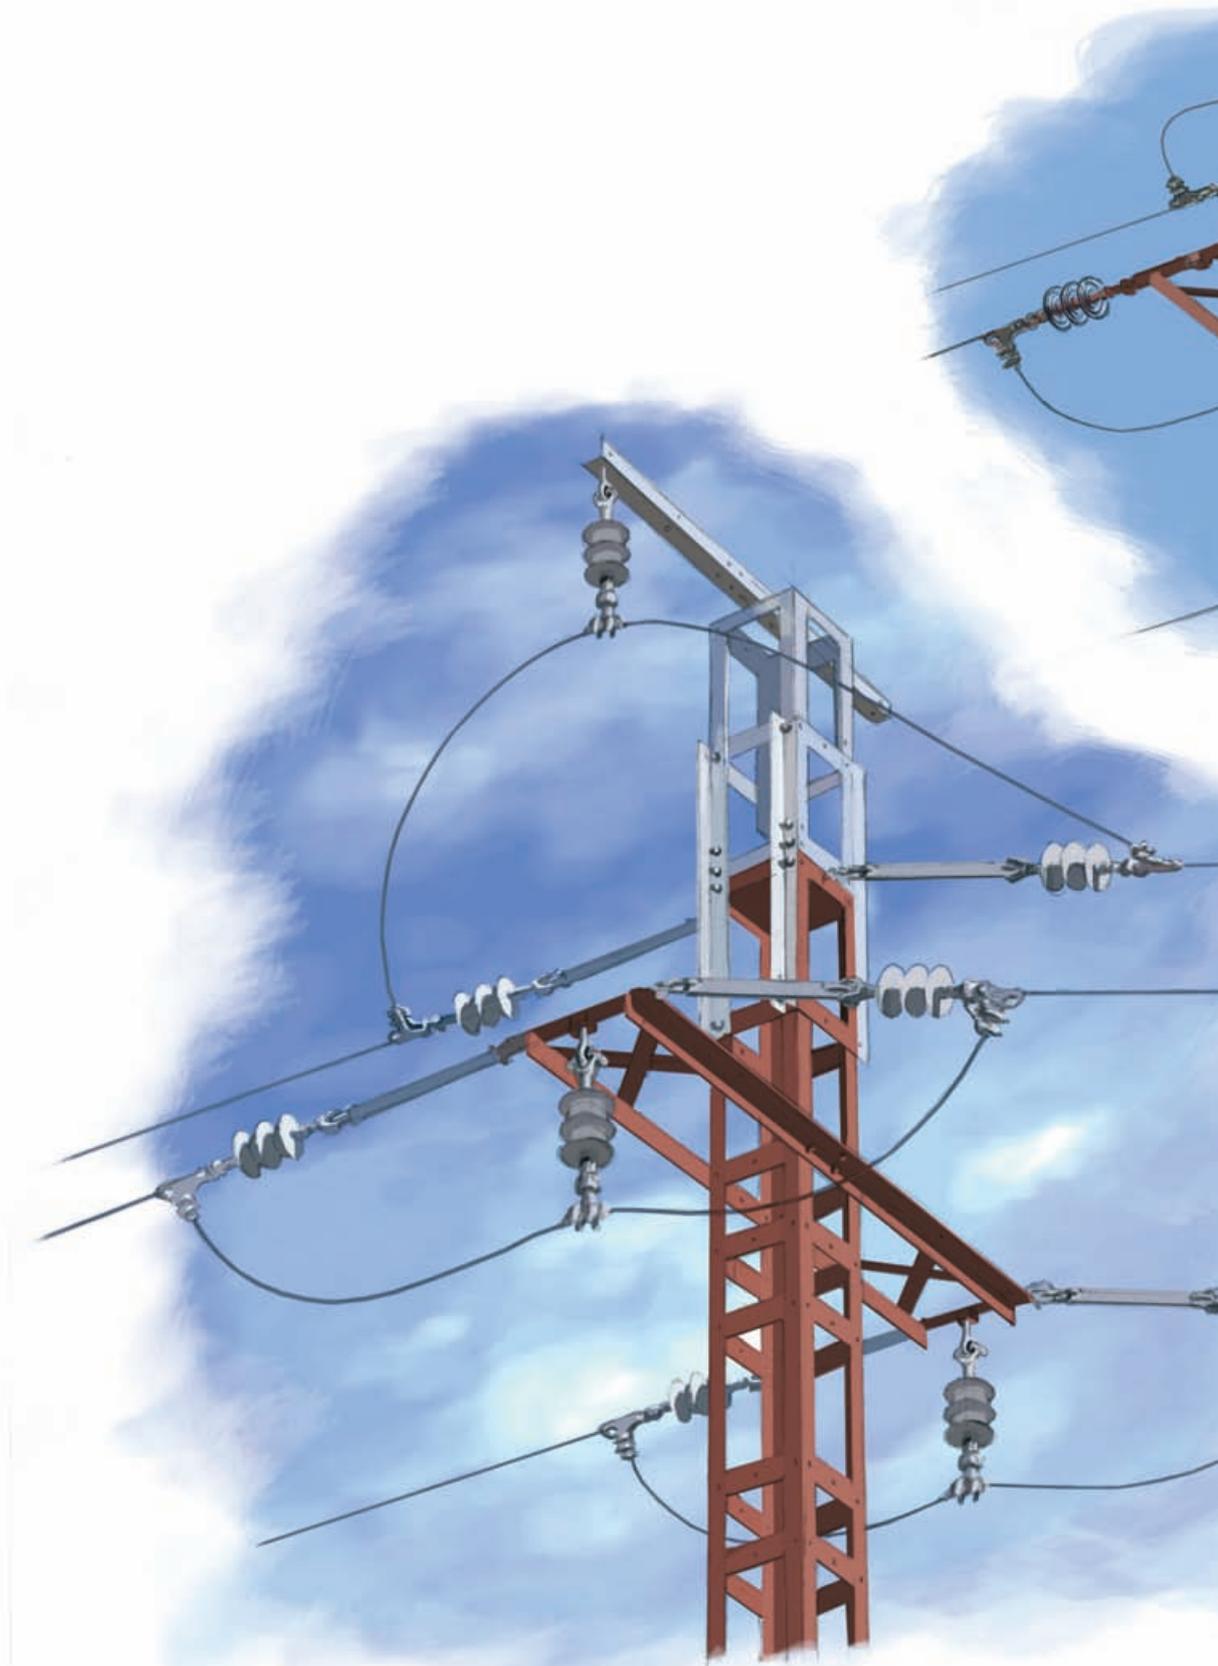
Solución antielectrocución para apoyo de amarre en montaje “1” y puente flojo central con aislador rígido.
